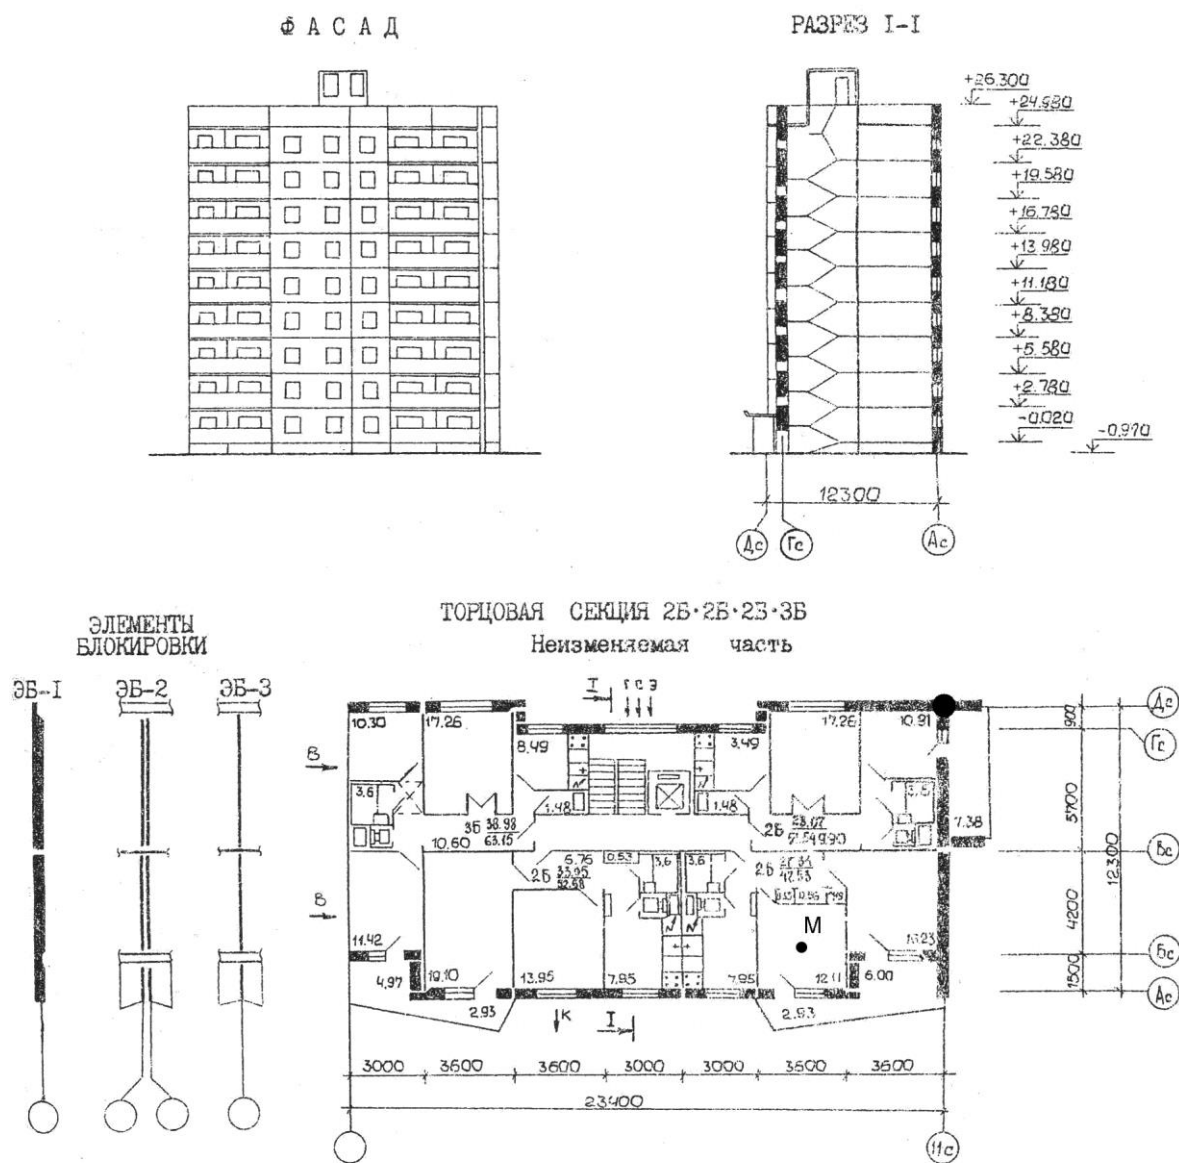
Фасад и план типового этажа (М 1:300)
